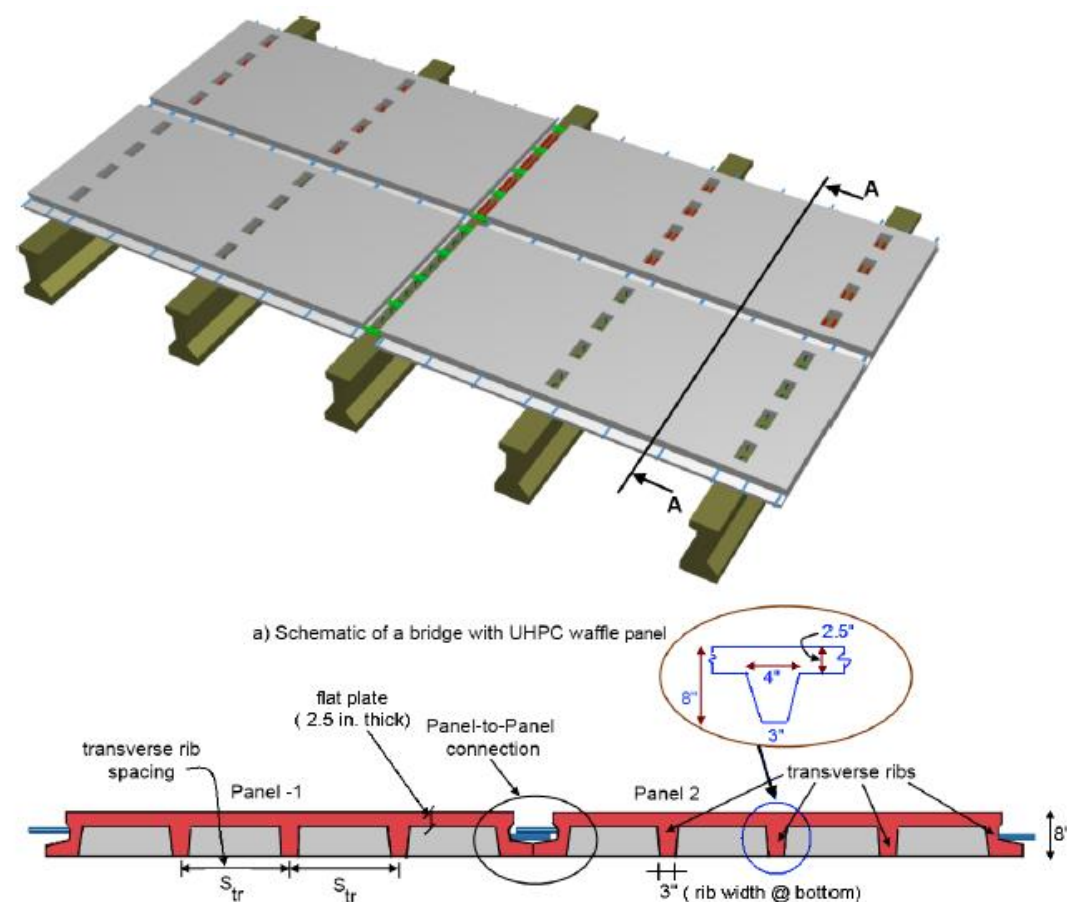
Visión general de los paneles tipo Waffle [FHWA 2013]
